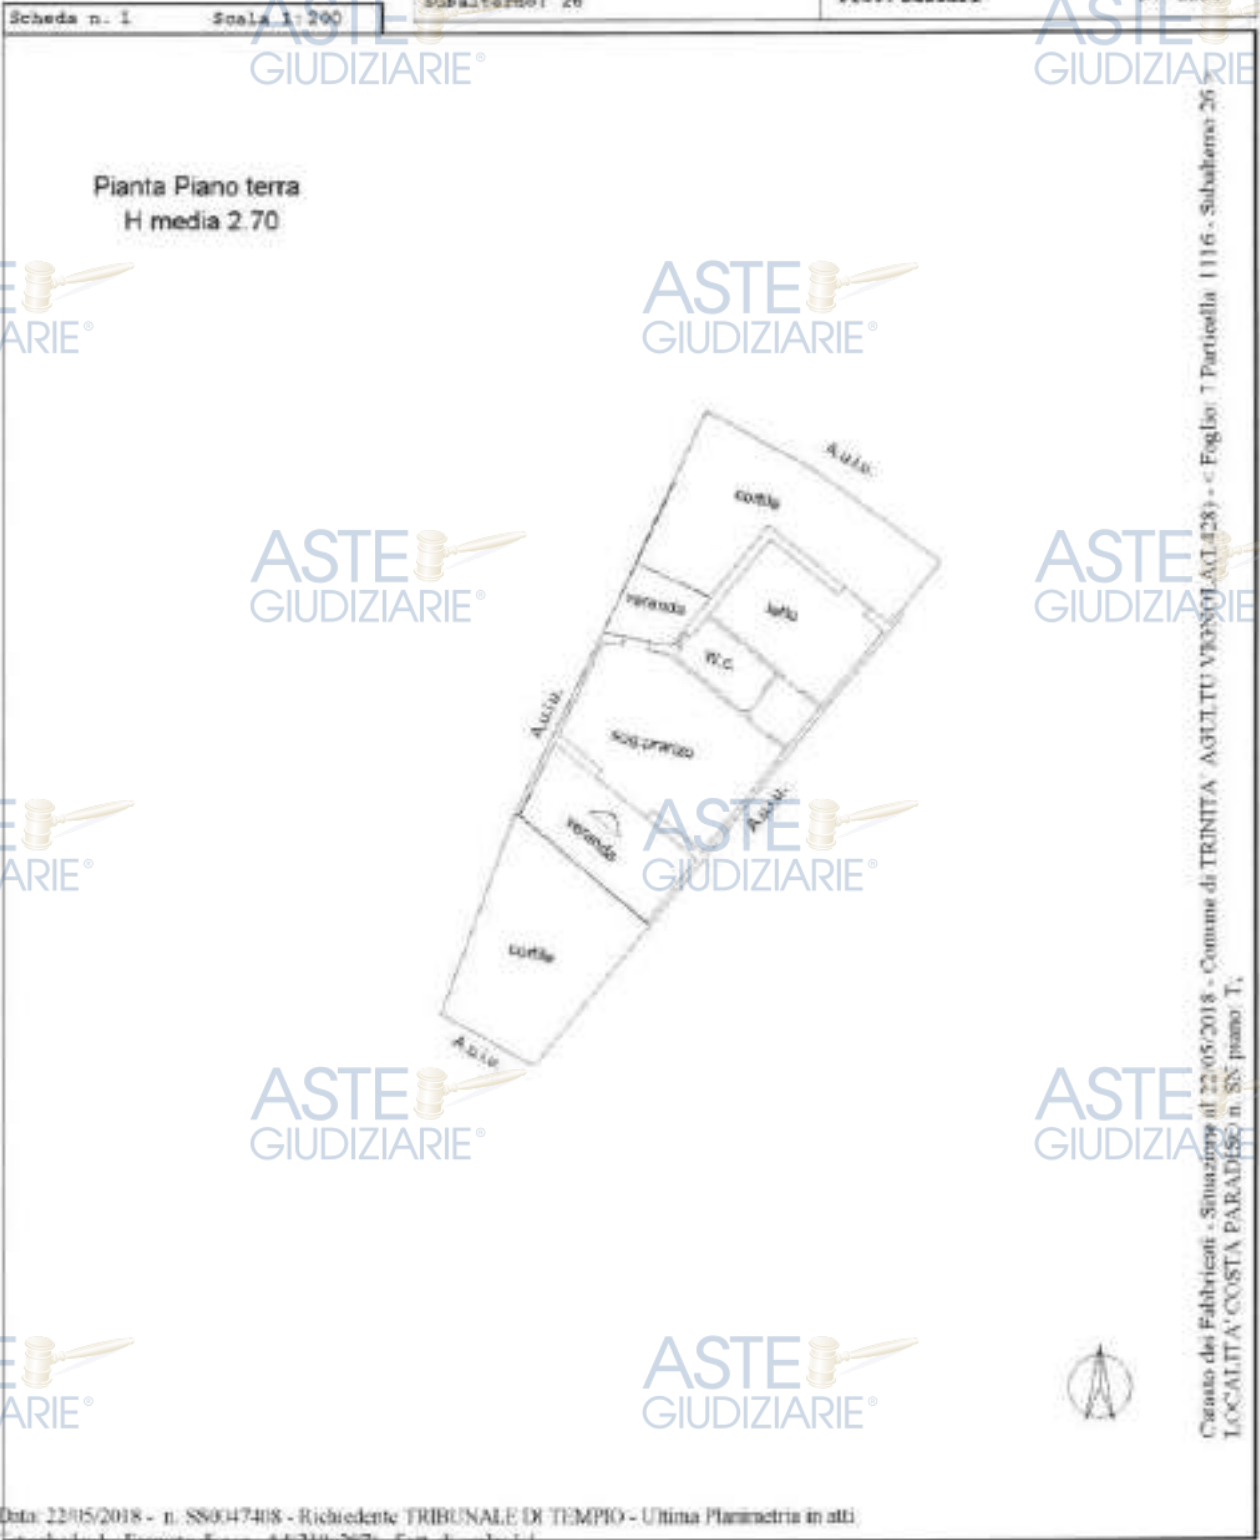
Visura planimetrica catastale Fig. 7 Part. 1116 Sub 26
